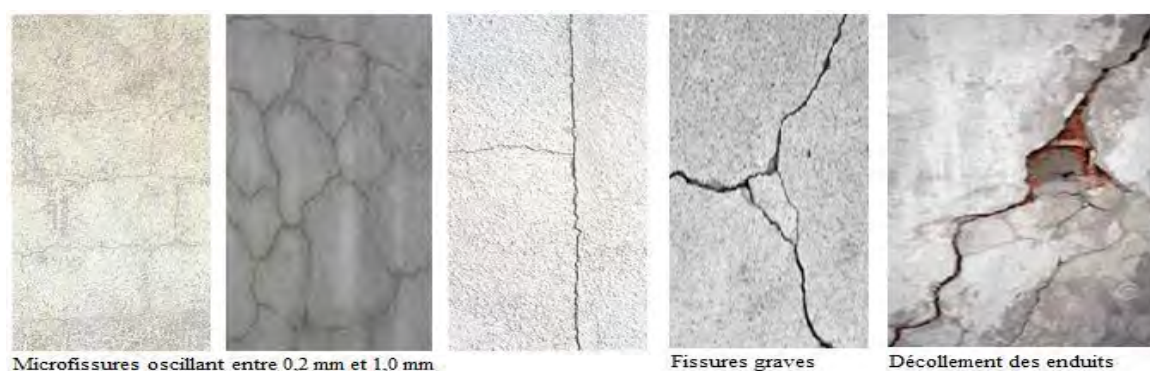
Les différentes formes de fissuration des enduits de façades.
